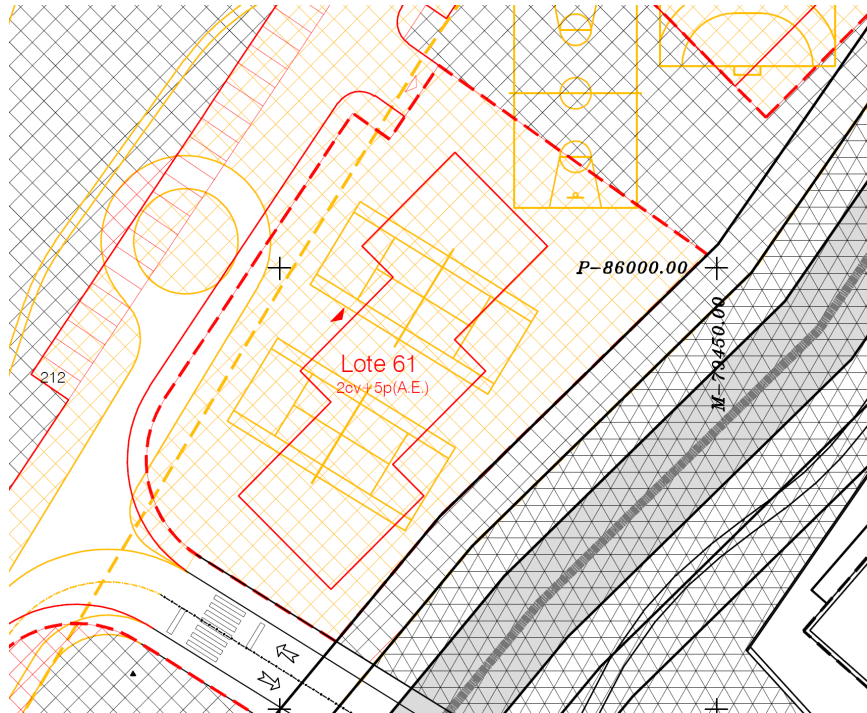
Implantação do lote 61, cuja utilização proposta é para Actividades Económicas (A.E).
